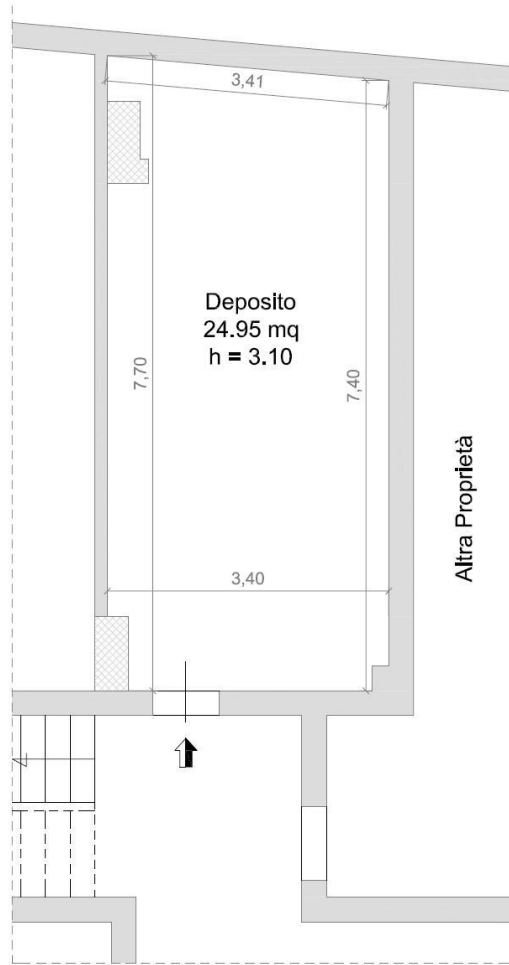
Planimetria Stato di fatto Foglio 105, p.lla 566, sub 7 (ex sub 3).
